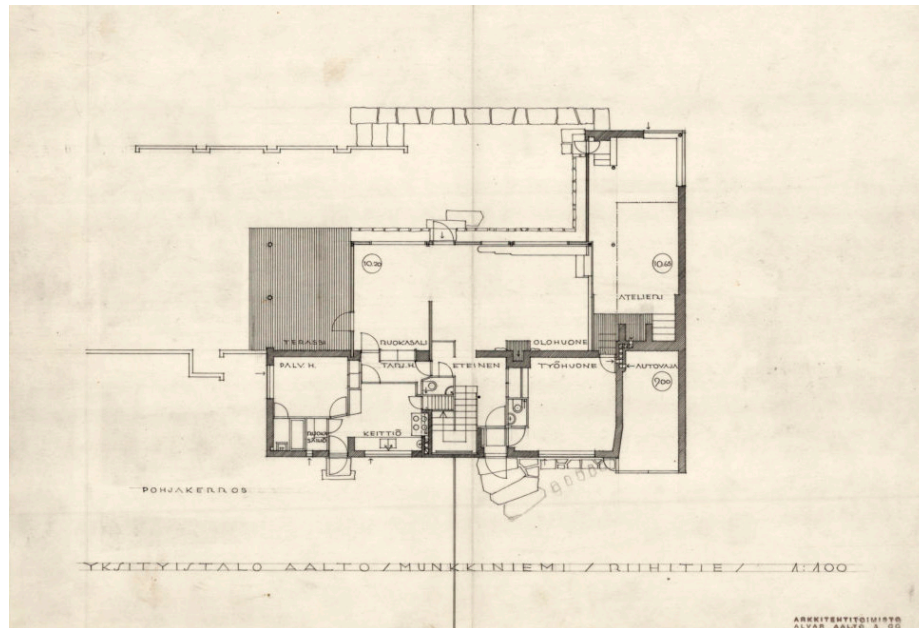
Planta baja de la Casa-estudio de Aalto
